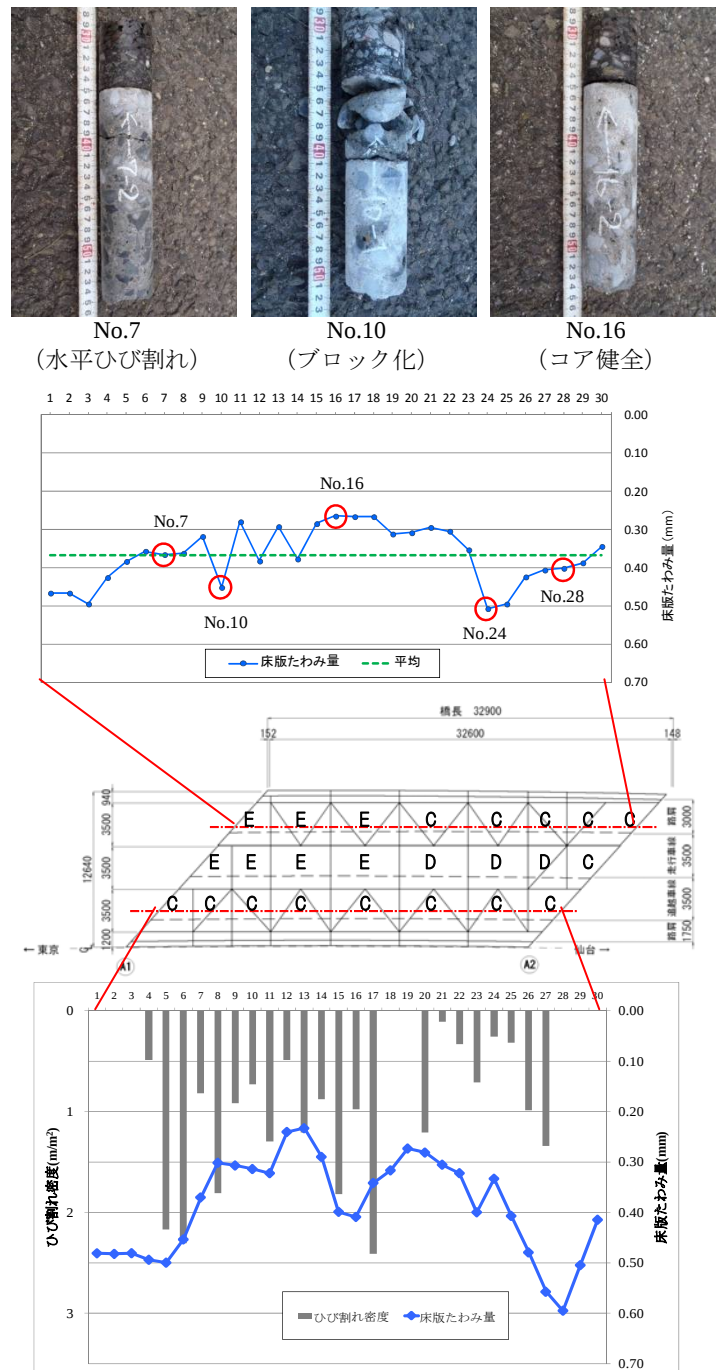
床版たわみ量とコンクリート性状・ひび割れ密度
